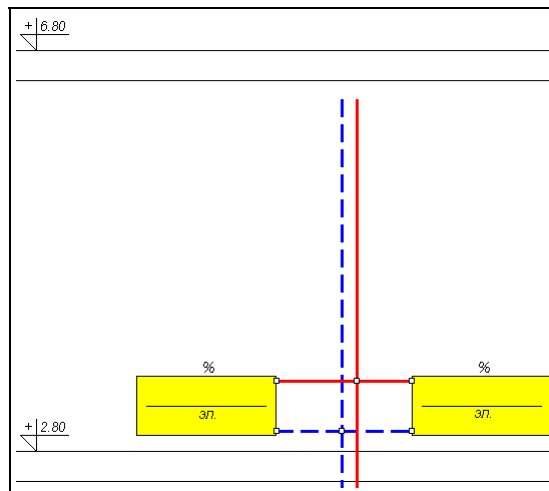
Фрагмент схемы с нарисованными трубопроводами
